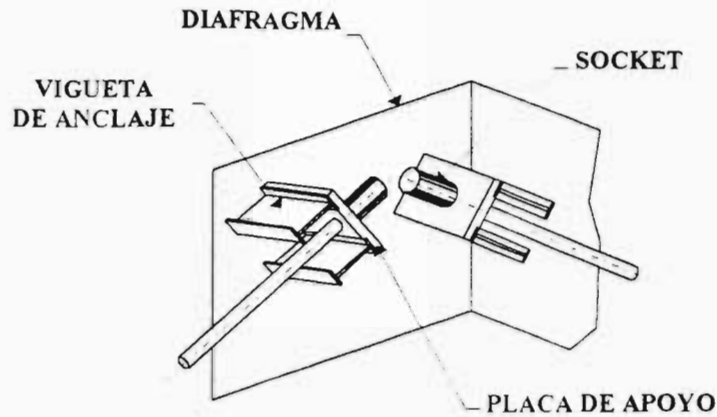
Estructura tipo vigueta para el anclaje de los cables en el pilar.
